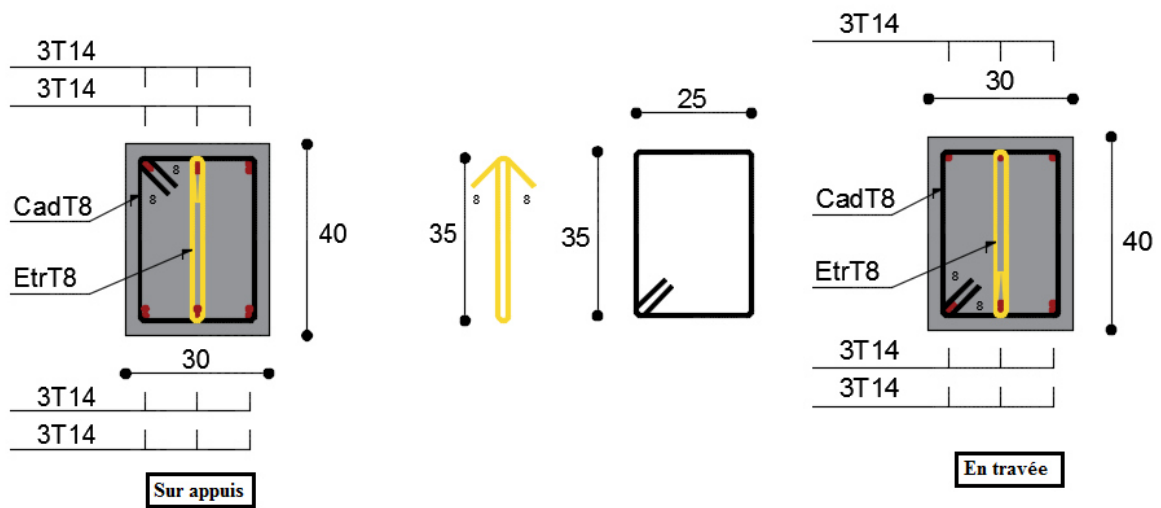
schéma de ferrailage des poutres principales en travée et en appuis (minaret).
